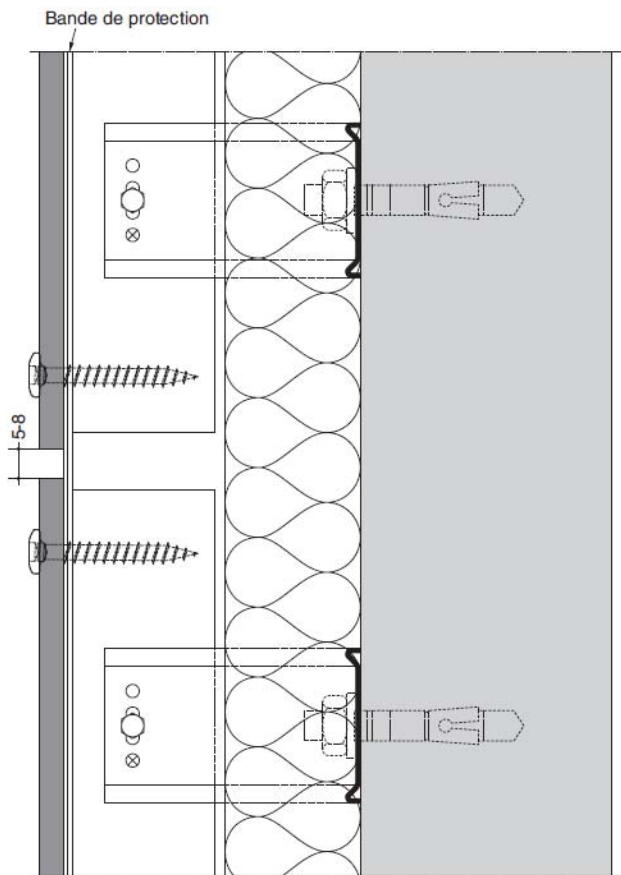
Coupe verticale sur joint horizontal (joint fermé)
